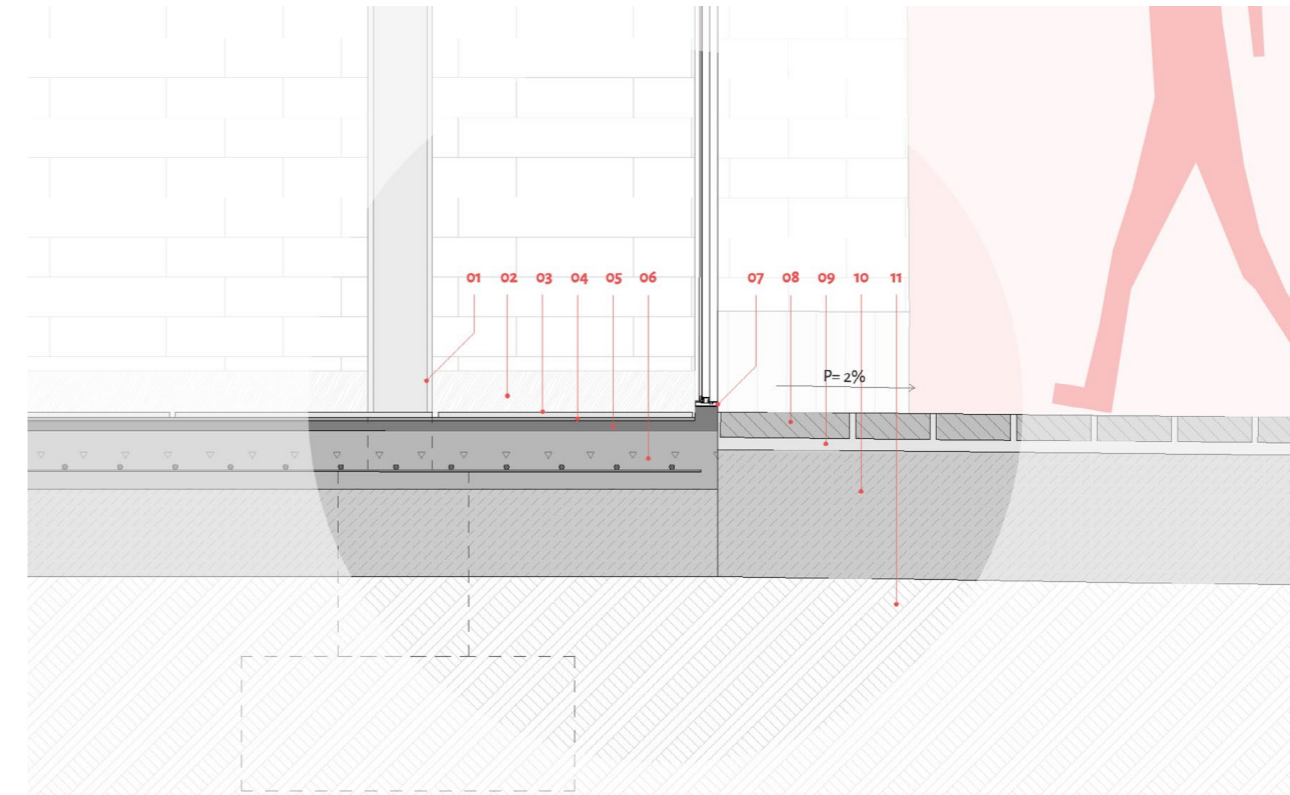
Detalle Constructivo 04 Fuente: Elaboración Propia
